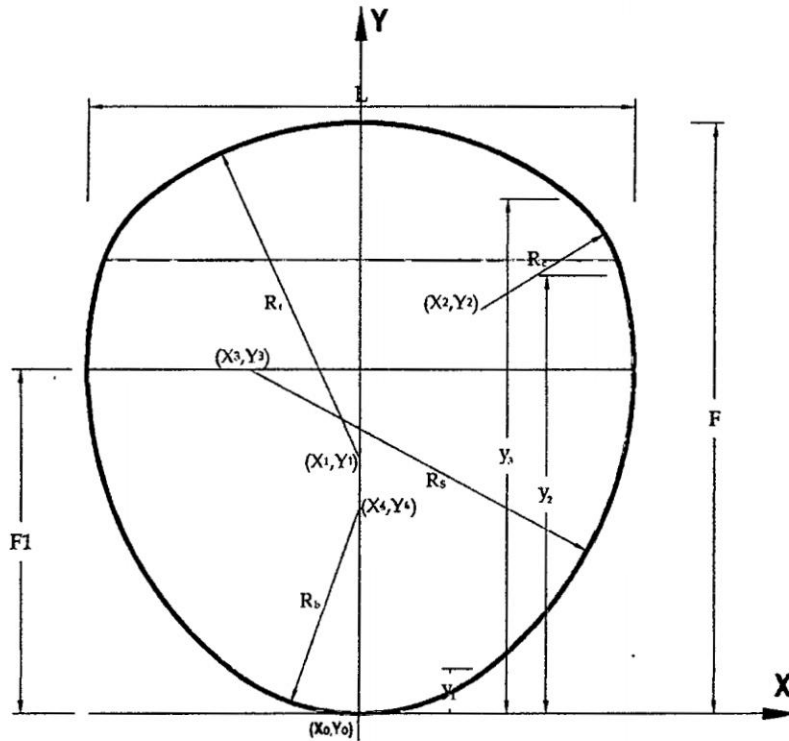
Alcantarilla de sección pera. Fuente: *Elaboración propia
